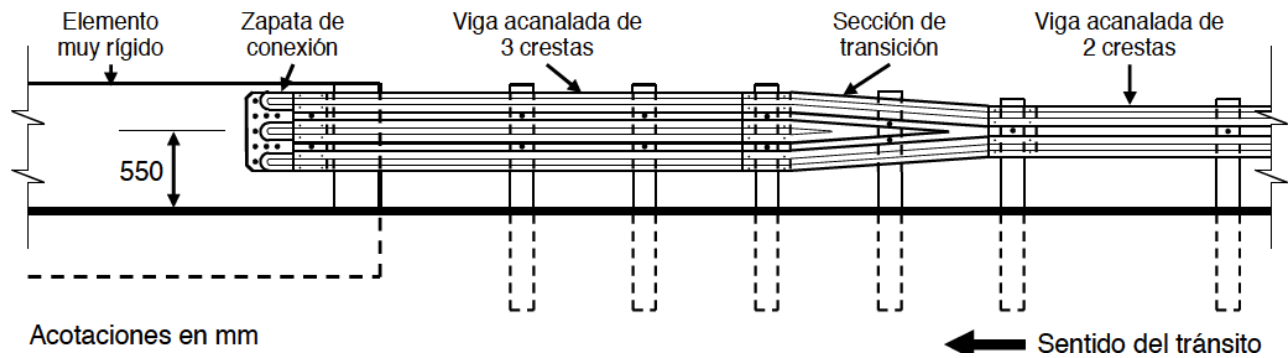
Transición de barrera metálica de dos a tres crestas y a muro vertical recto
